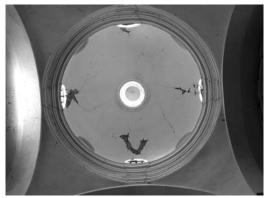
San Antonio en Pianella. Cúpula (foto D'Avino 2009)
